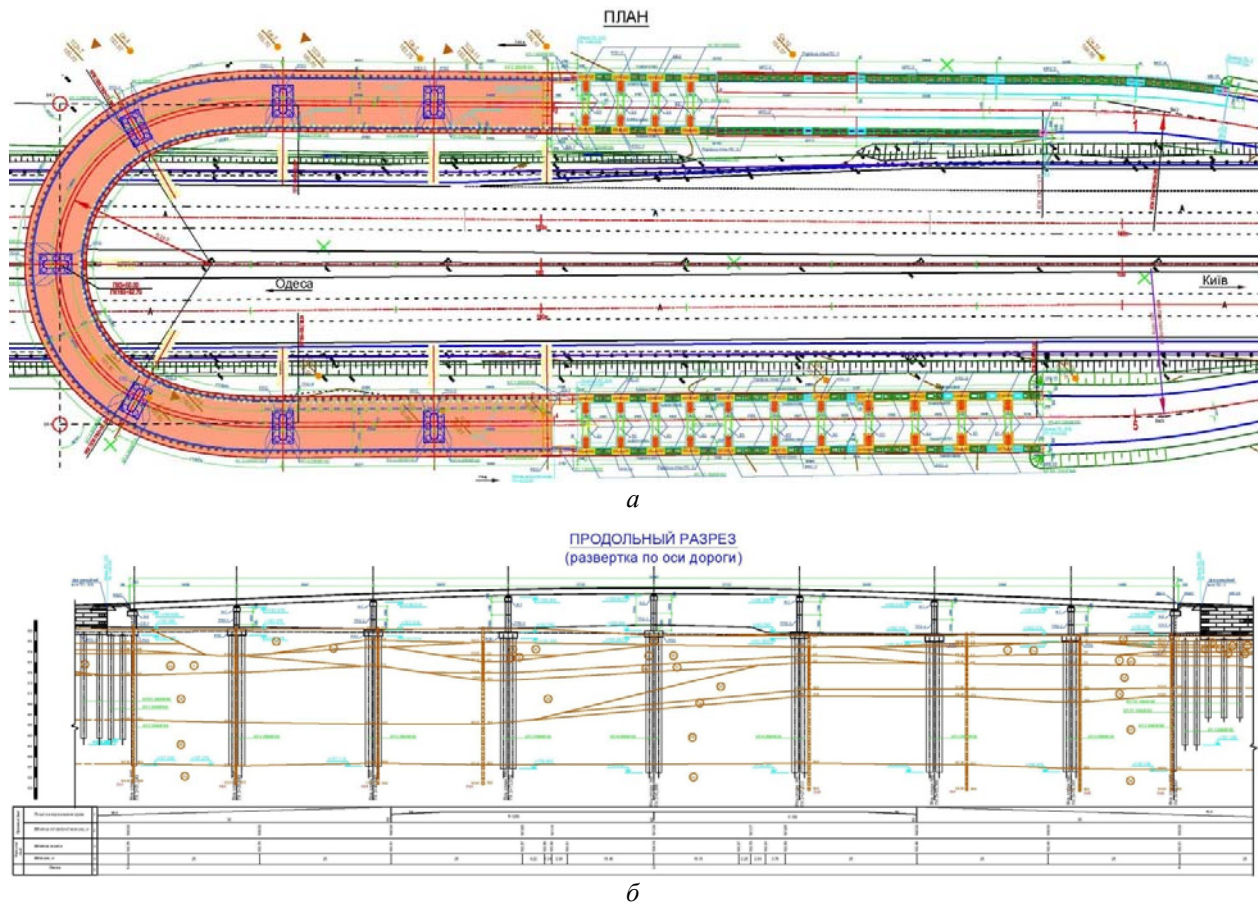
План (а) та поздовжній (б) розріз шляхопроводу
